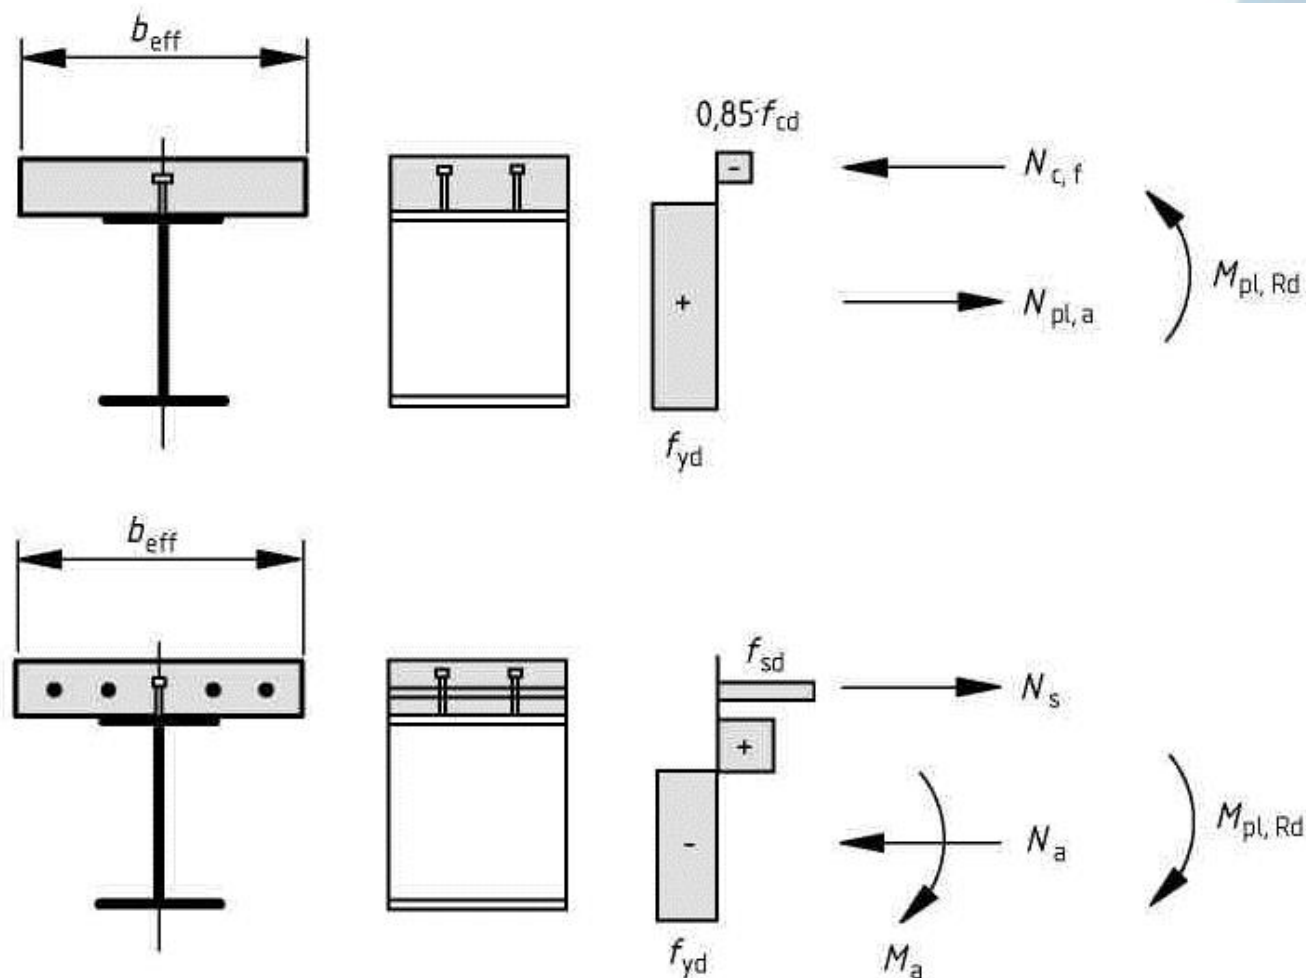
Примеры распределения напряжений в сталежелезобетонном сечении балки с полным объединением
